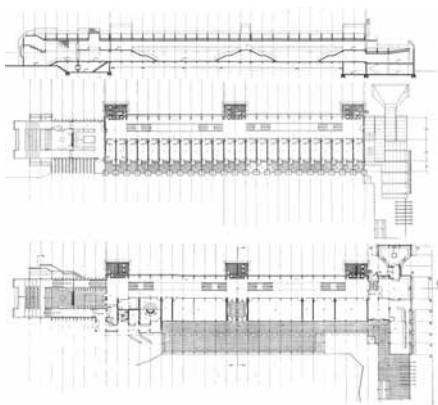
Planos de proyecto del Carmelo de San José. 6a) sección longitudinal del edificio que muestra la secuencia interior entre los diferentes niveles. 6b) planta alta, con galería interior de acceso a celdas y al fondo el ventanal hacia la terraza de servicio y acceso a cubierta. 6c) planta de acceso a zonas de visita, capilla, refectorio y áreas de trabajo organizadas por tránsito interior. Fuente: FERNÁNDEZ ALBA, A. (1971). Carmelo de San José en Salamanca, *Revista Arquitectura*, Madrid, 1971, n. 147, pp. 2-11.
